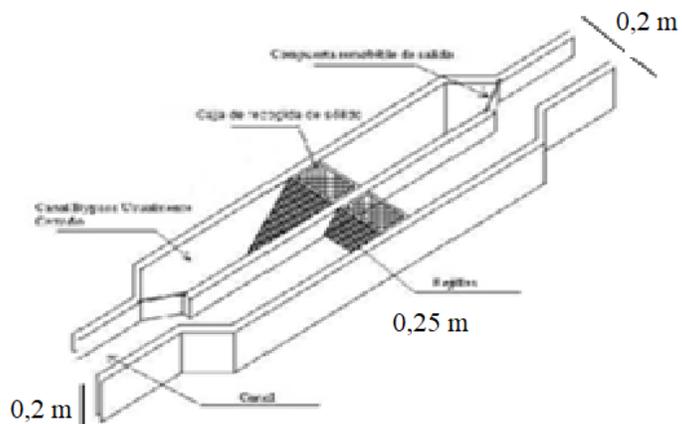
Ilustración de la rejilla en planta Fuente: (Ibañez,2008)
